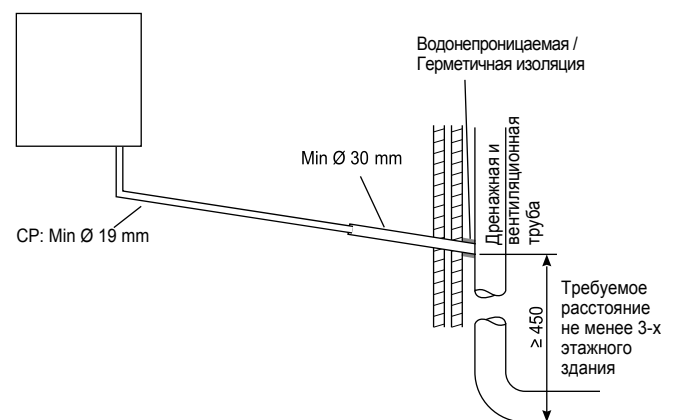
Подключение конденсатоотводчика к дренажной и вентиляционной трубе
